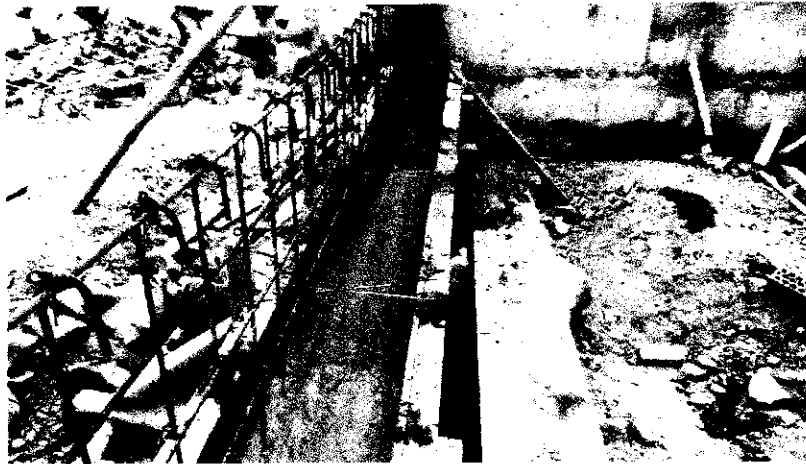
Vaciado de concreto en cimientos (muros, concretó simple y armado).
